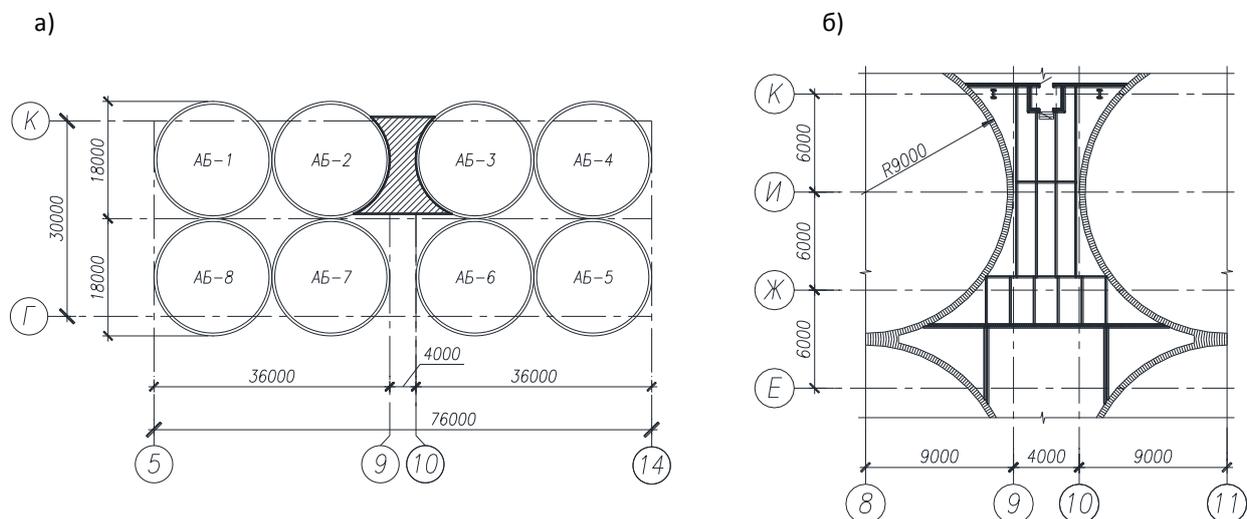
Схема расположения помещений между бункерами: а) блок аккумулирующих бункеров; б) помещения между бункерами
